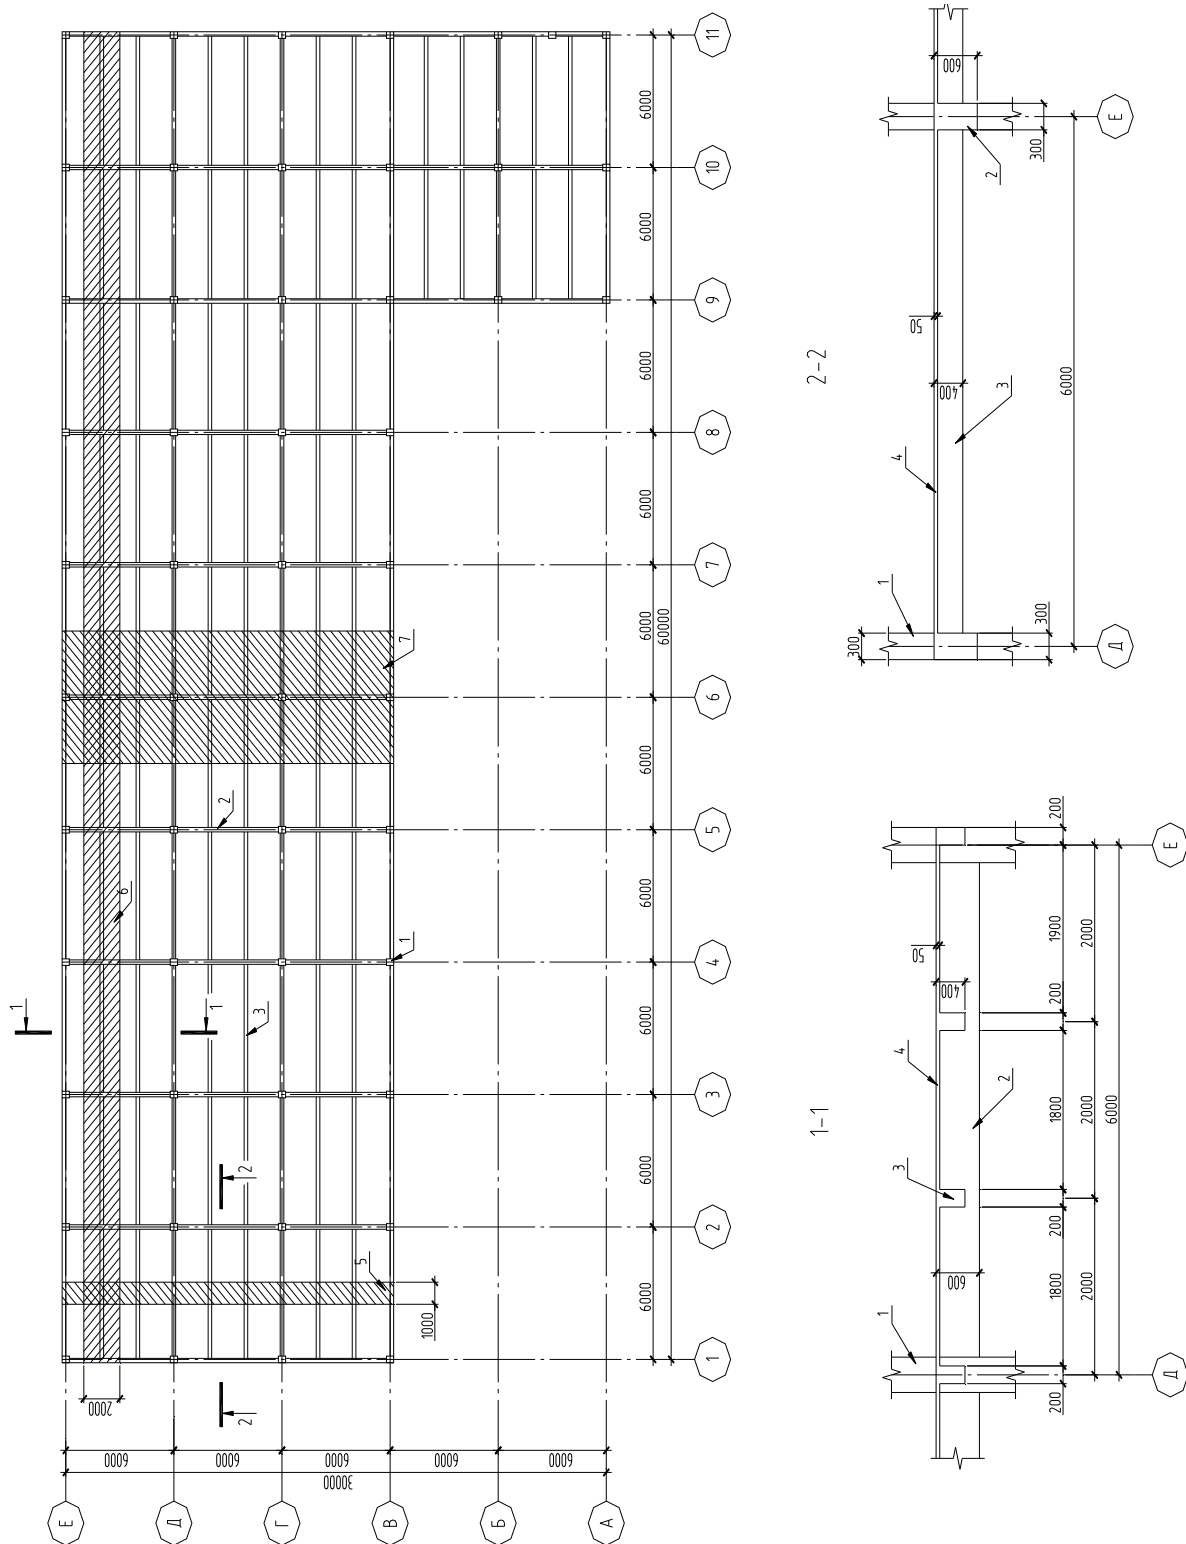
Конструктивна схема монолітного ребристого перекриття:
